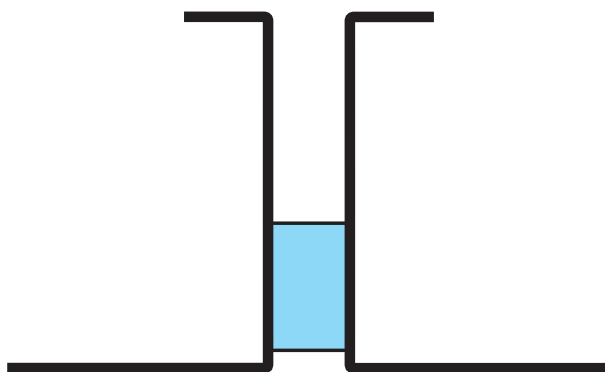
joints verticaux et horizontaux entre cassettes en aluminium
